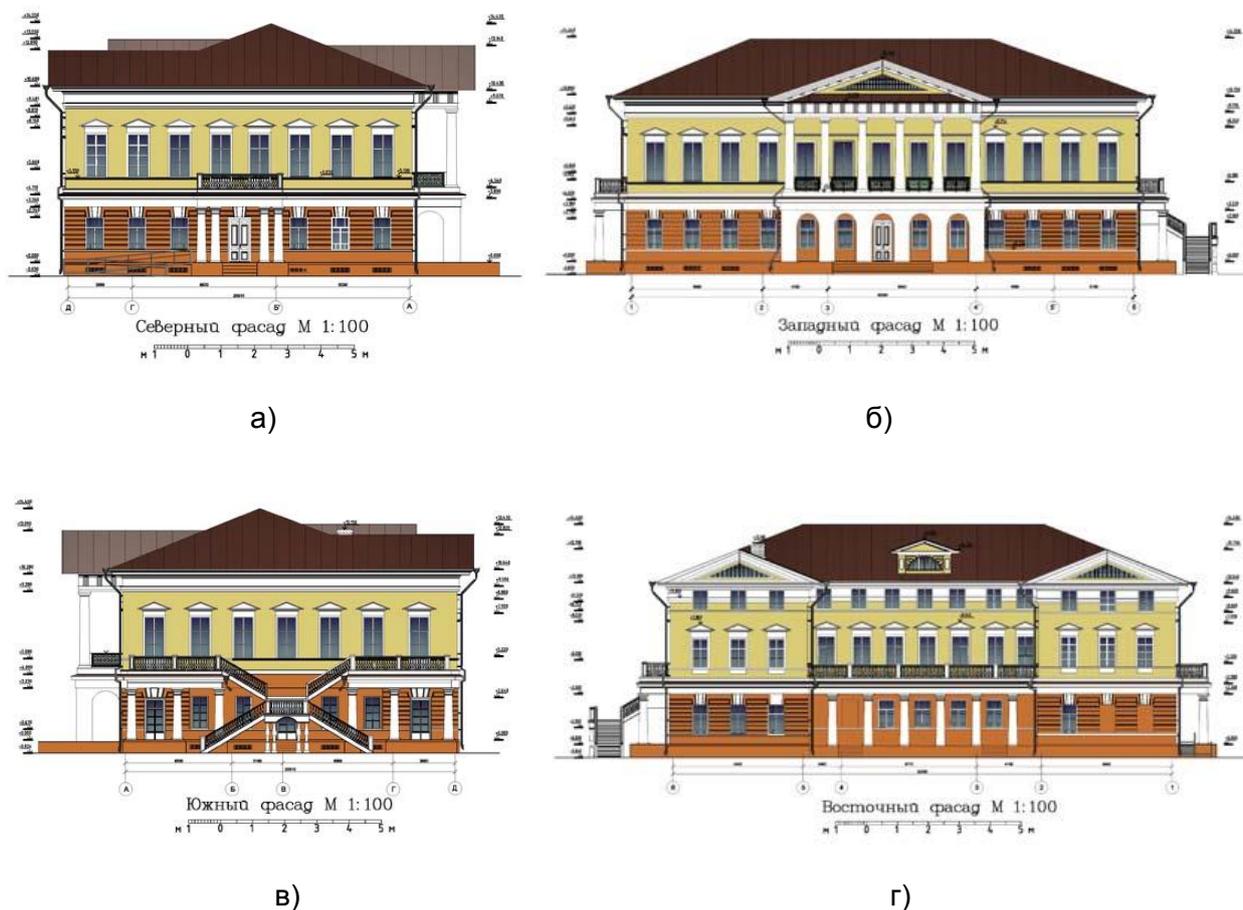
Главный дом: а) северо-западный фасад с главным входом в дом; б) главный юго-западный фасад с портиком по оси; в) боковой ажурный юго-восточный фасад с балконом, на который вели две лестницы. Этот фасад дома был обращен в парк; г) северо-восточный фасад с балконом между двумя ризалитами, покоящемся на колоннах. Этот фасад был обращен на парадный (Белый) двор (проект реставрации выполнен АУК ВО «Вологдареставрация», 2019 г. Руководитель авторского коллектива И.К. Белоярская)
